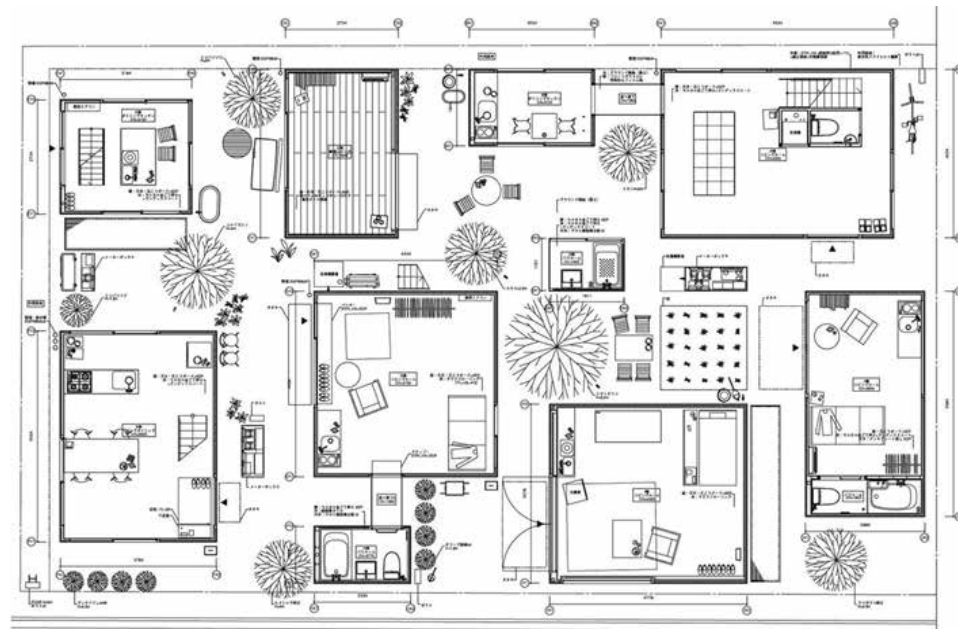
Planta do projeto de Ryue Nishizawa em Tóquio.
